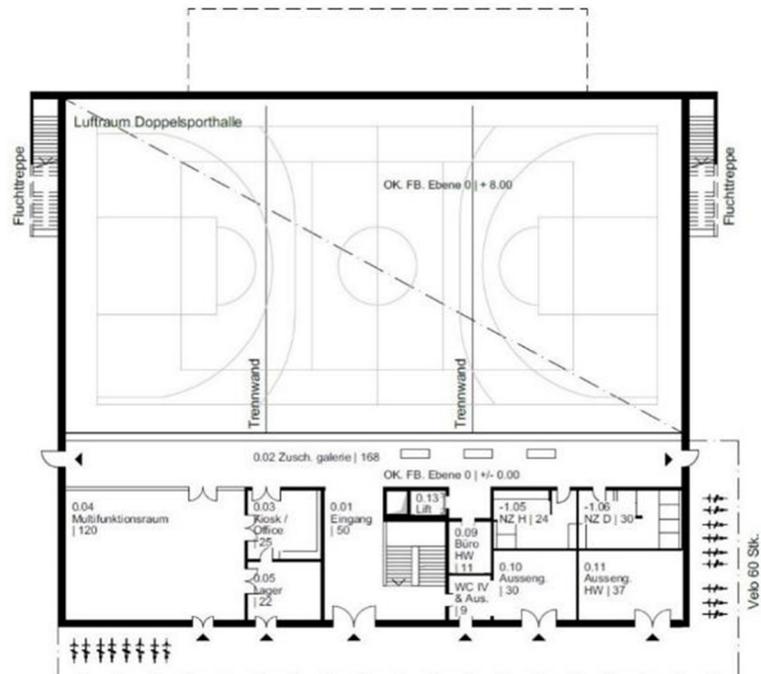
„versenkte“ Doppelsporthalle B | Disposition 1 - Grundriss Erdgeschoss
